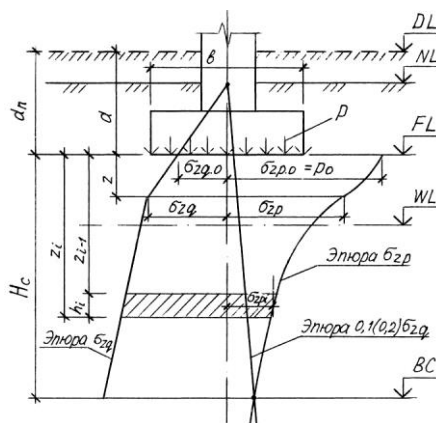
Распределение вертикальных нормальных напряжений в грунтовой толще:
